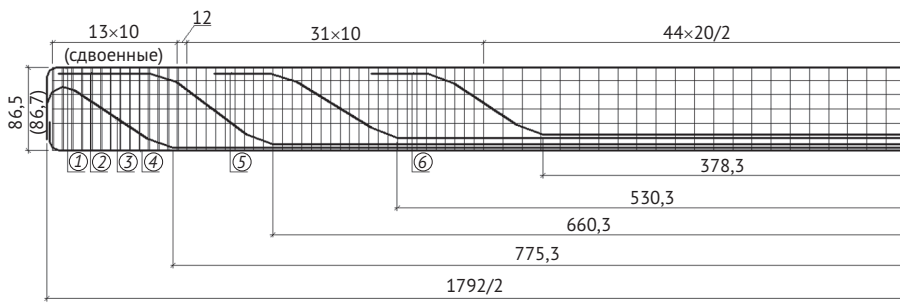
Схема армирования балки ненапрягаемой арматурой (полная длина, м — 18; типовой проект: серия 3.503.1-73 Союздорпроект (Москва) 1986 г.; под нагрузку А11 и НК-80)
